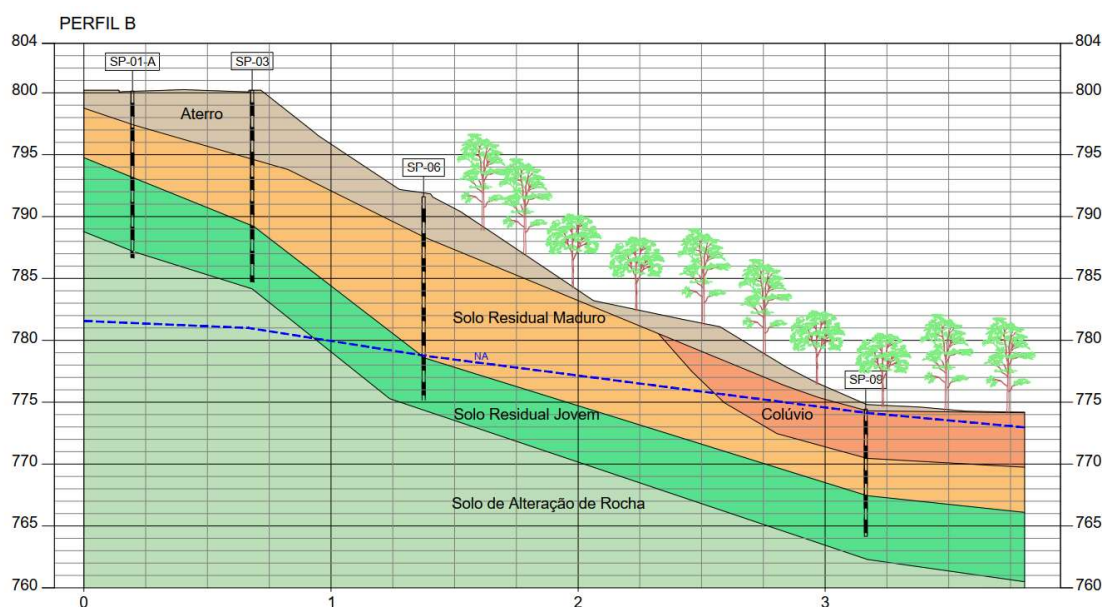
Perfil geotécnico traçado com base nas sondagens SPT executadas sobre o talude.
